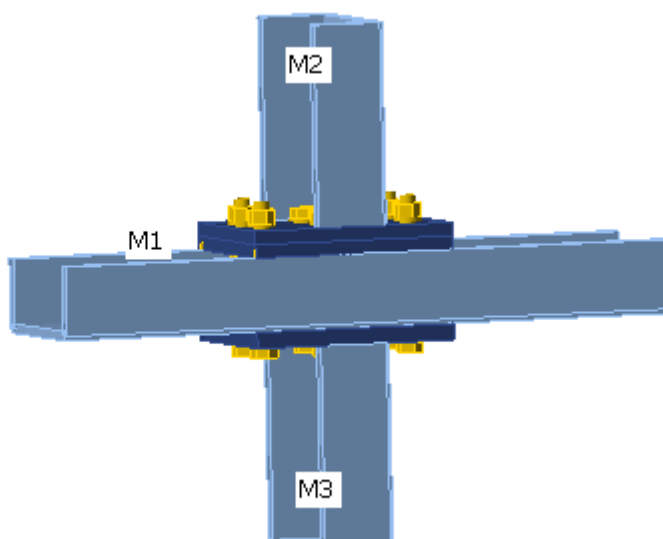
Connessione pilastrino parapetto – Output Idea statica.
